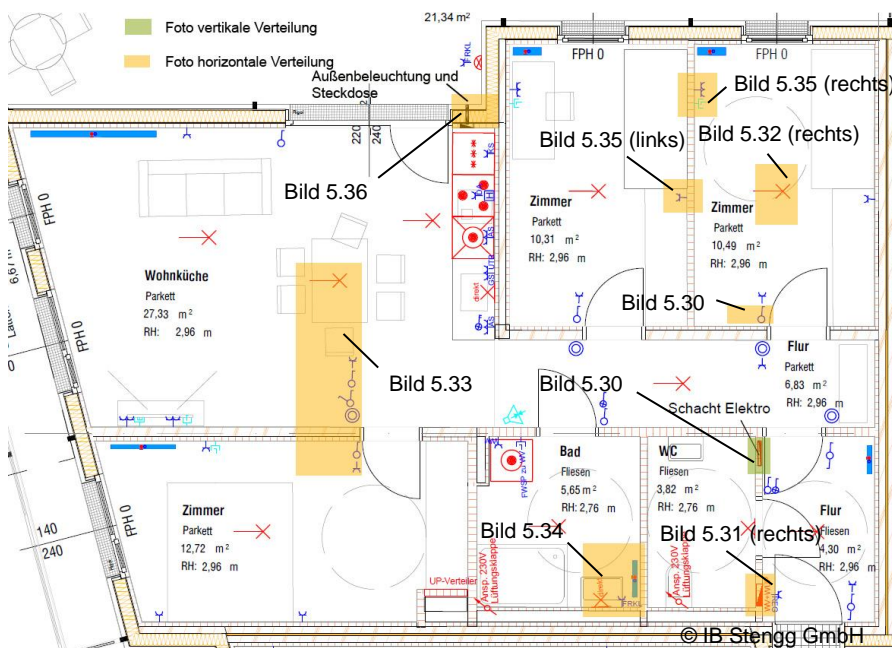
Grundrissdarstellung der Elektroinstallation
